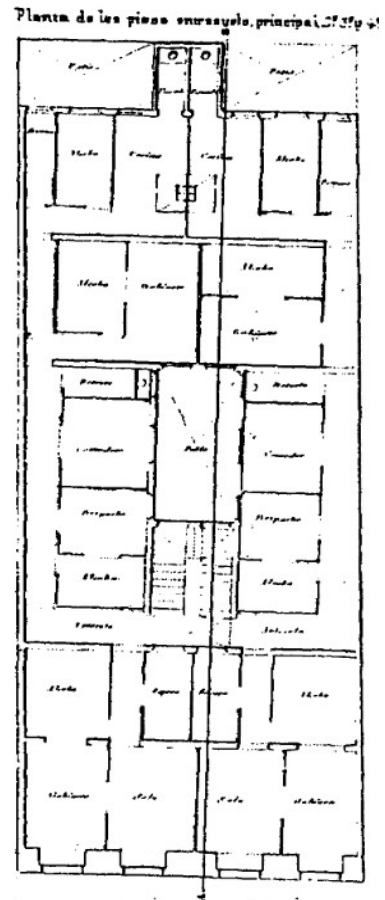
Calle de Lagasca 8, Grundriss Zwischengeschoss, Hauptgeschoss, 2., 3. und 4. Stockwerk
